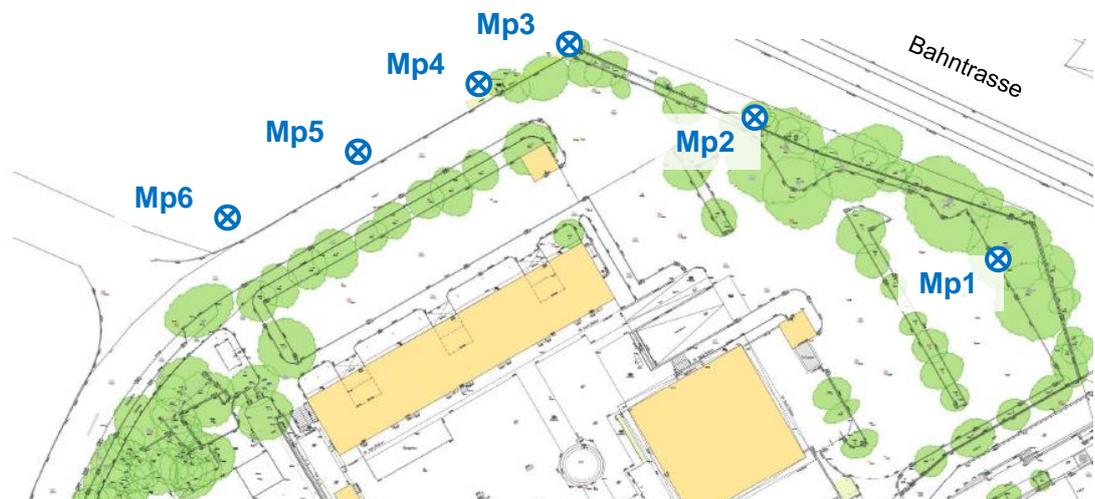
Plangebiet mit Lage der Messpunkte.
